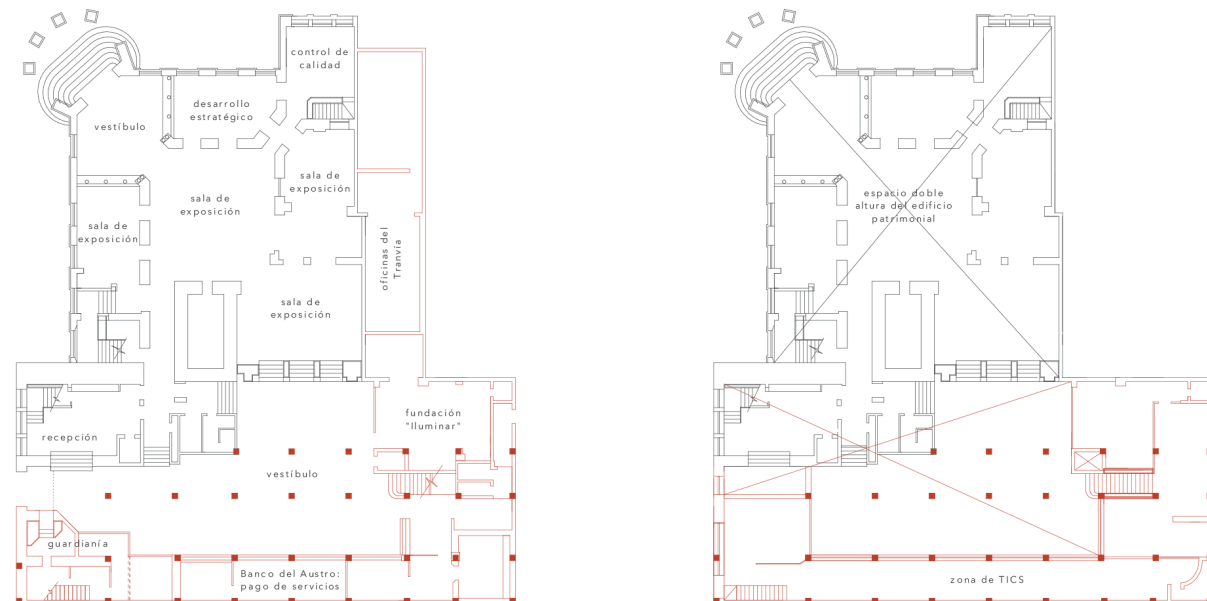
Planta baja y mezanine. Gráficos de la autora.
